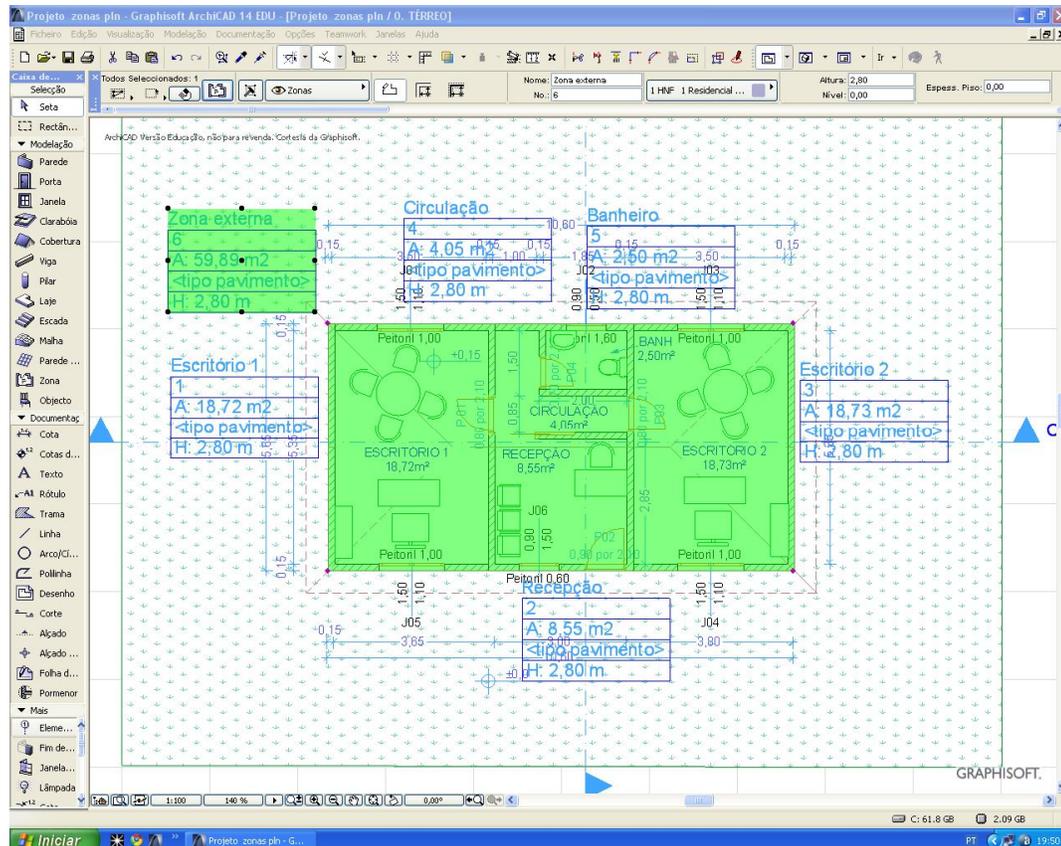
Planta baixa modelo no *software* ArchiCAD 14 com zona externa definida.
